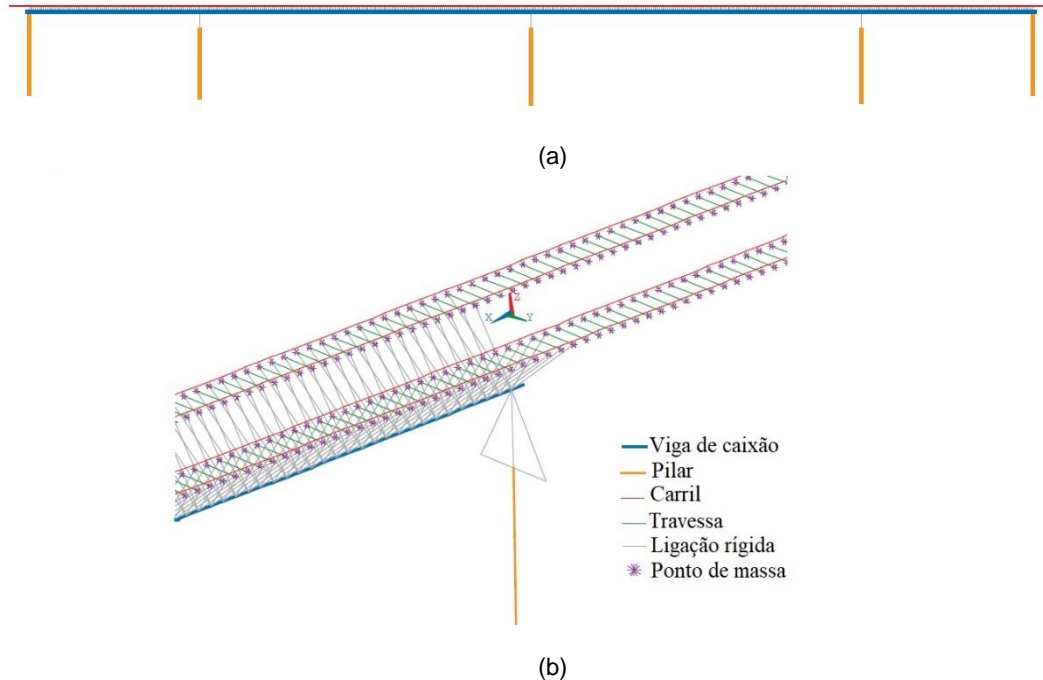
4 - Modelo numérico da ponte de betão pré-esforçado:(a) alçado e (b) isometria do pormenor de ligação entre o tabuleiro e o pilar (Montenegro 2018).
